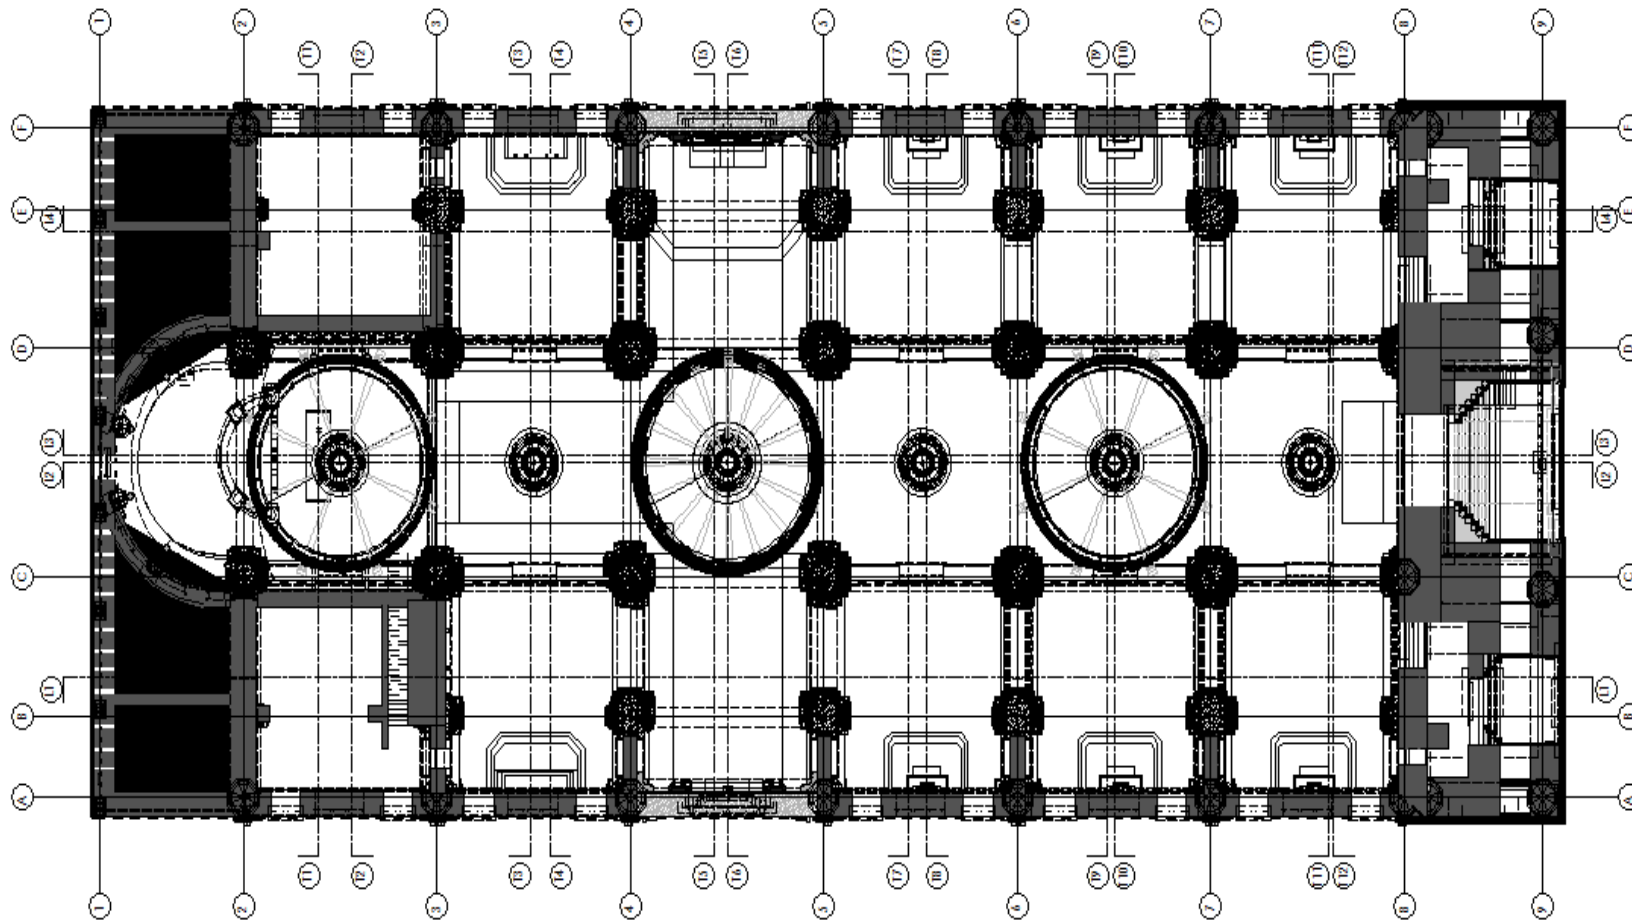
Plano General en planta de la Catedral de Cuenca
